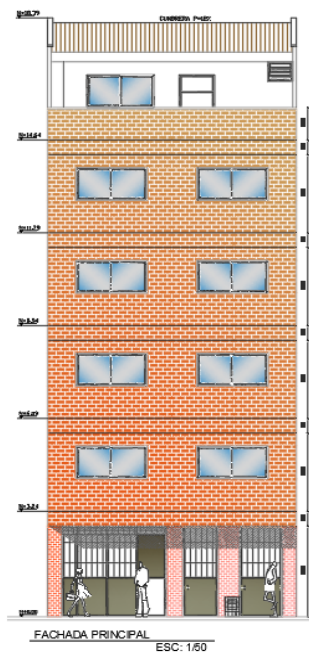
Plano estructural elaborado en AutoCAD para el proyecto La Universidad – Faustino.
